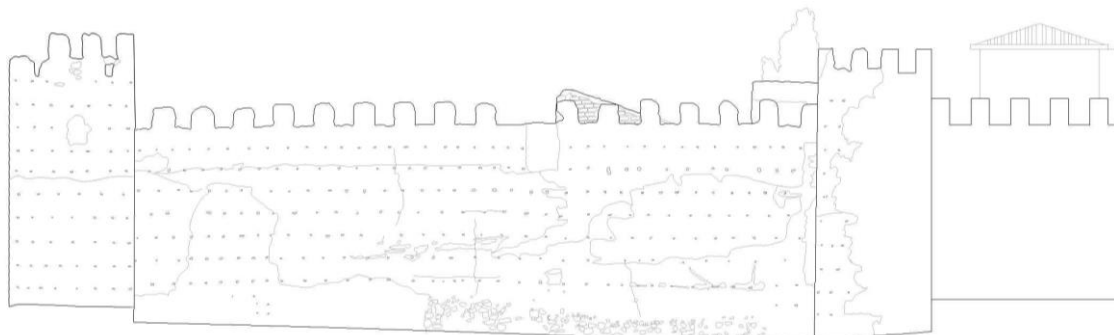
Alzado Norte TA, L1 y TB. Escala 1/200. Fuente: Autora.
